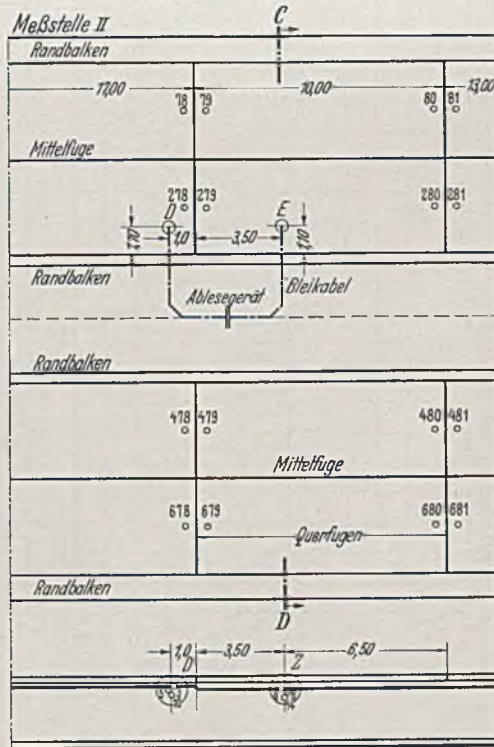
Einbauplan der elektrischen Fernmeßanlagen.
